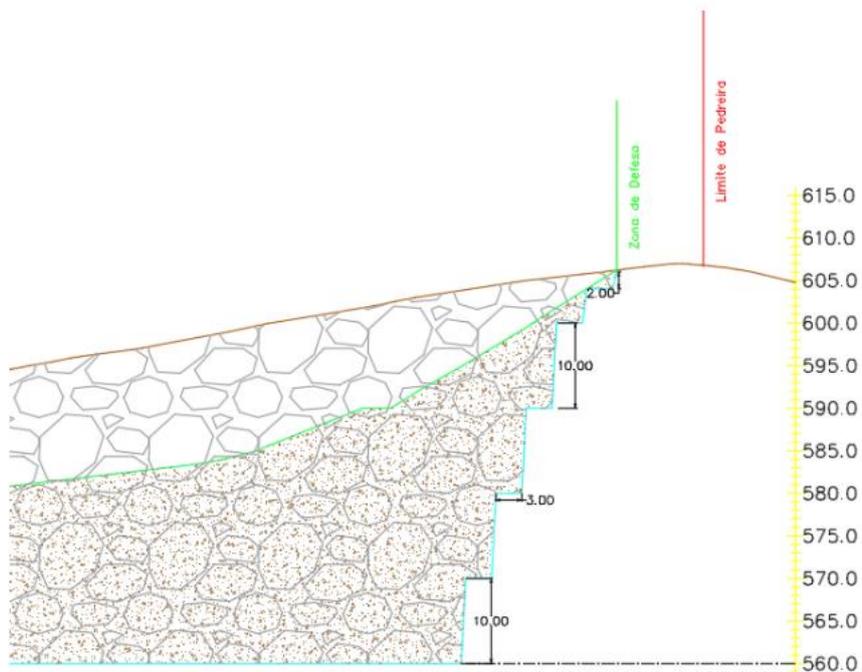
Configuração final das bancadas (perfil n.º 5). Fonte: Plano de Lavra
